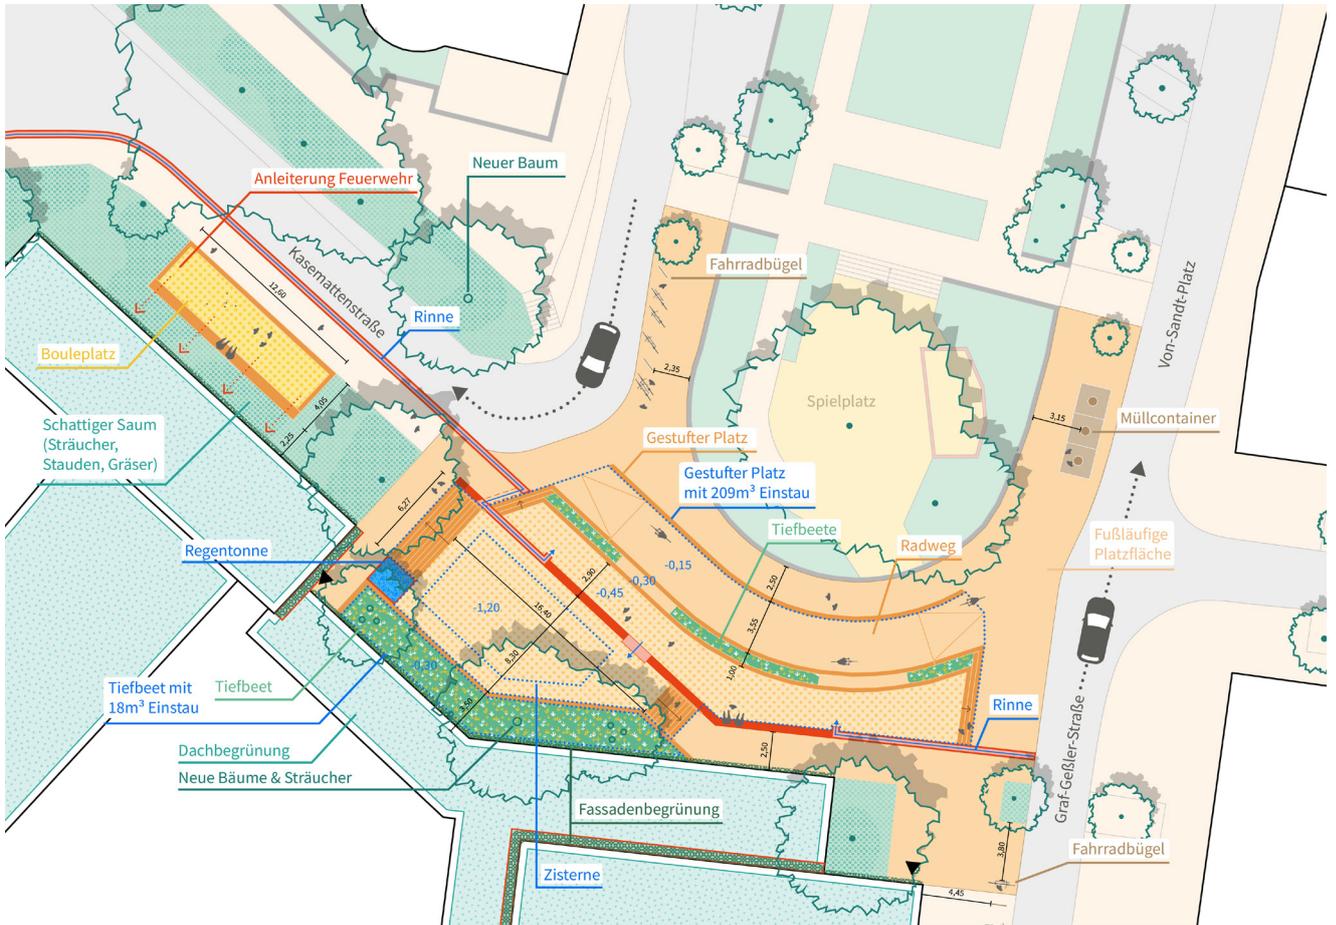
Vorschlag 1.1.A – Grundriss Gesamtsituation
